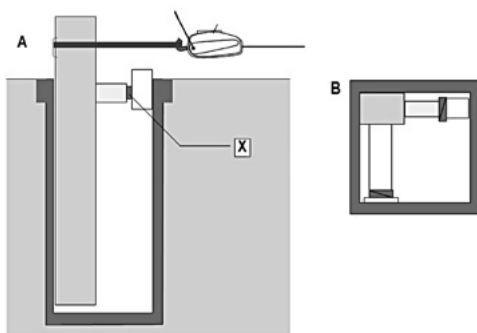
Ancoraggio sulla parete posteriore del pozzetto con cuneo (X), in sezione (A) e in pianta (B)
